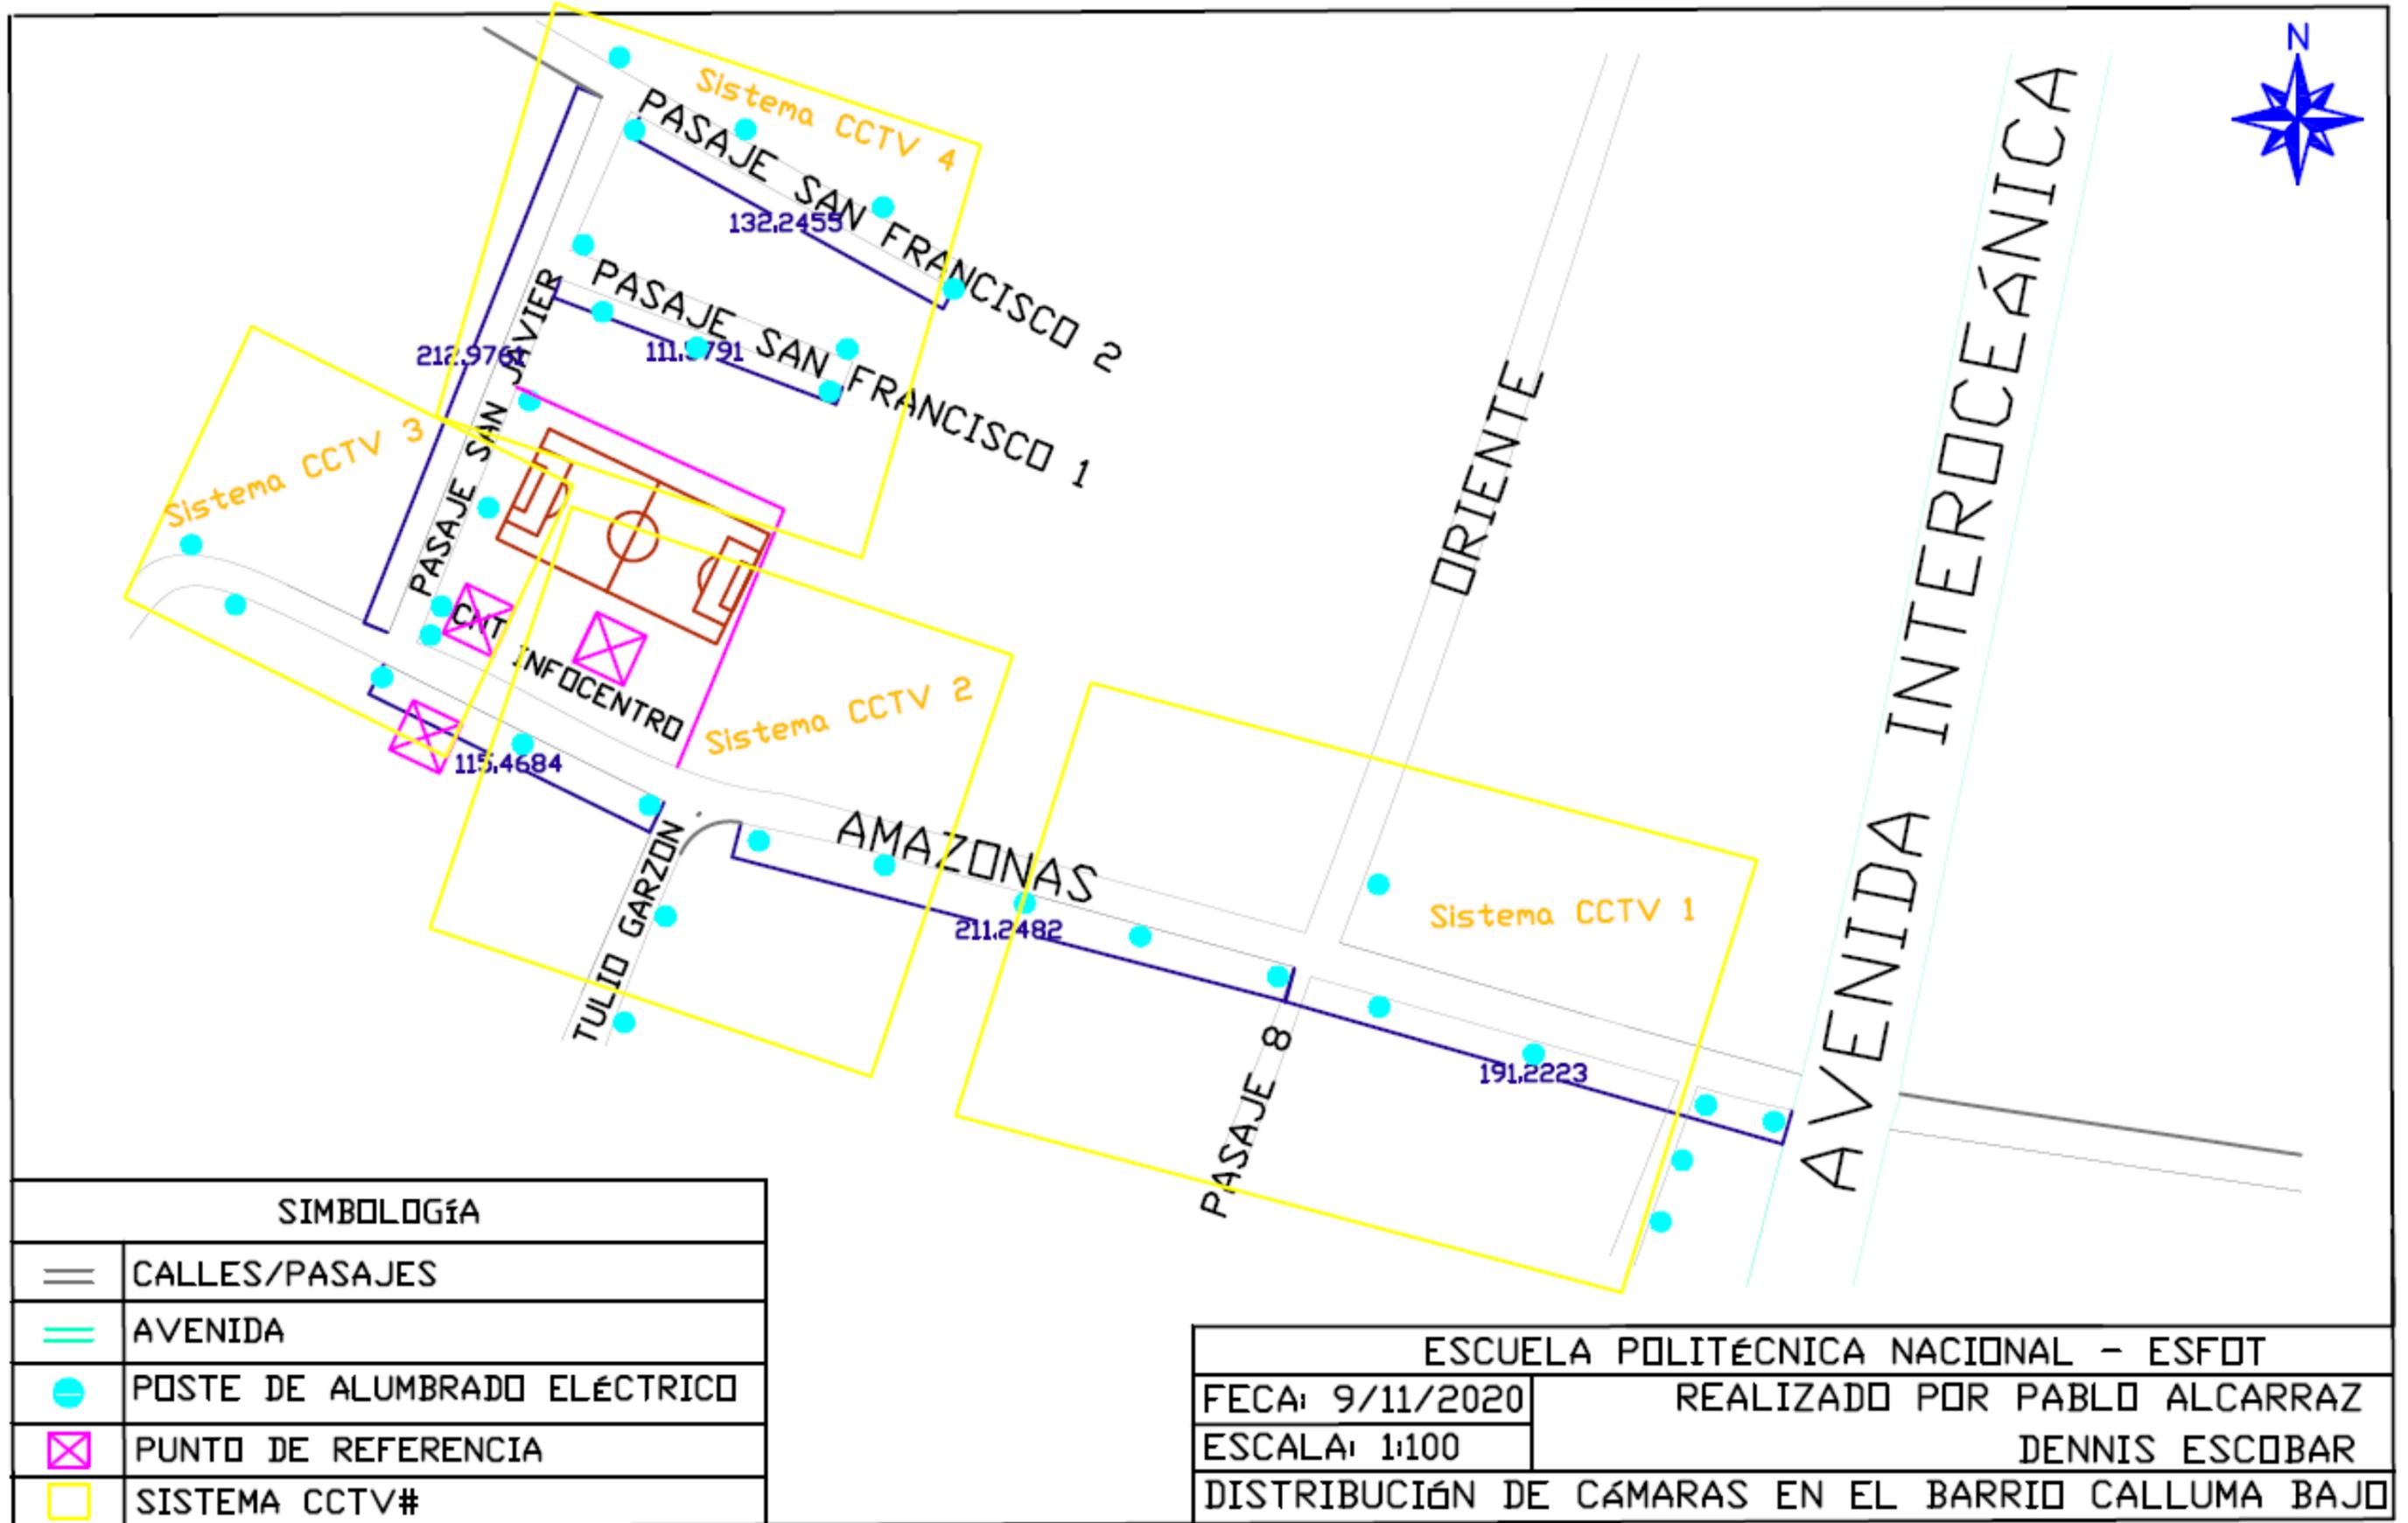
Plano de calles y pasajes del barrio Calluma Bajo
